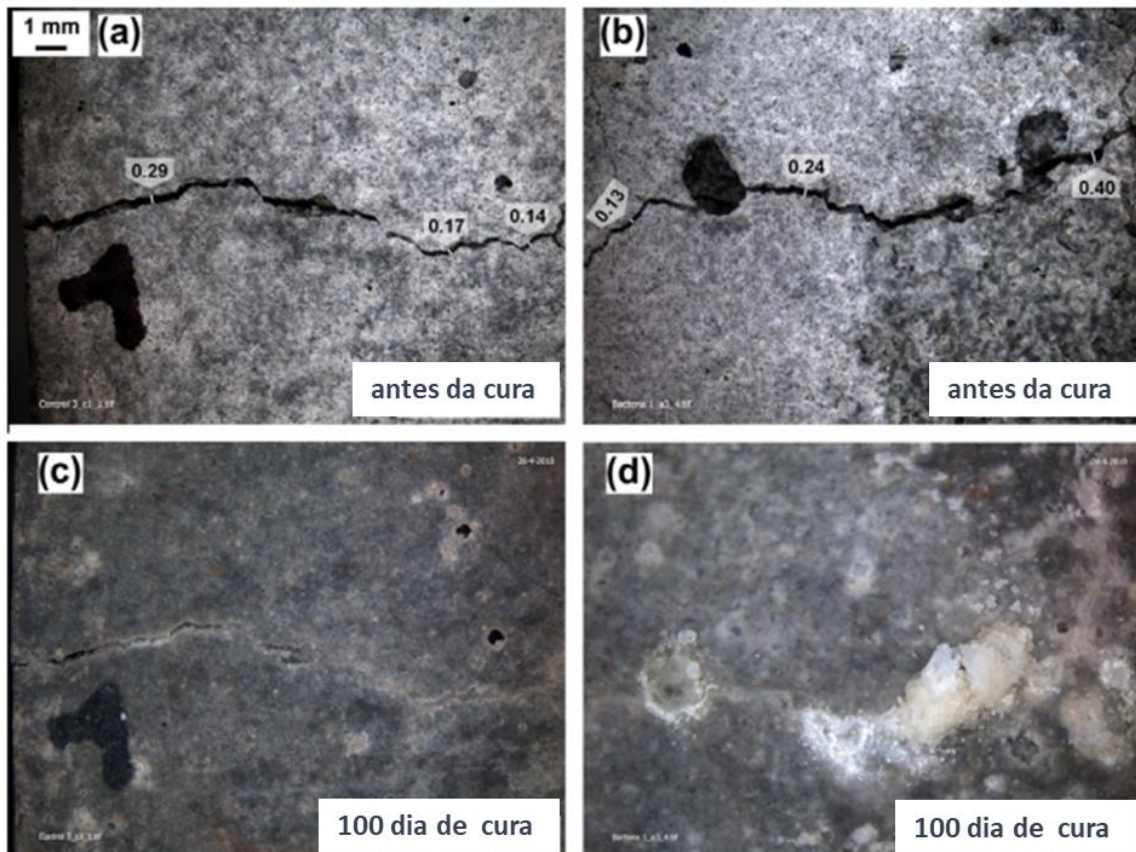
(a) concreto fissurado (b) bioconcreto fissurado (c) 100 dias após do concreto fissurado (d) 100 dias após do bioconcreto fissurado
